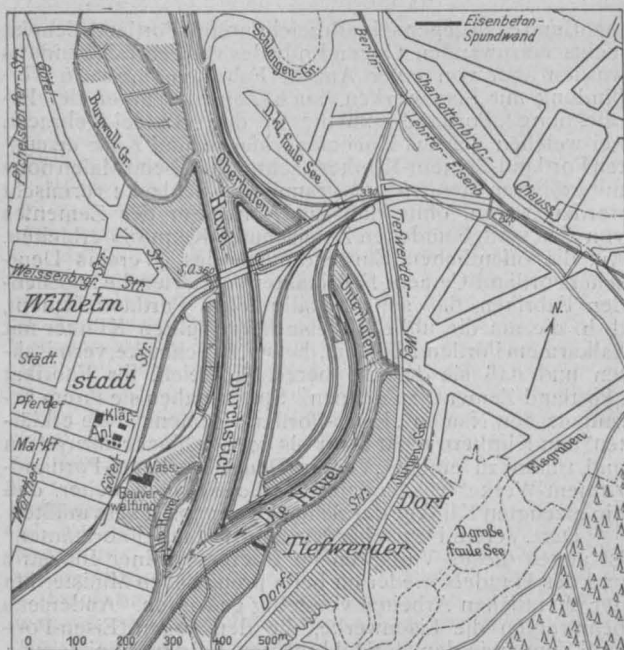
Lageplan des neuen Hafens bei Spandau.
